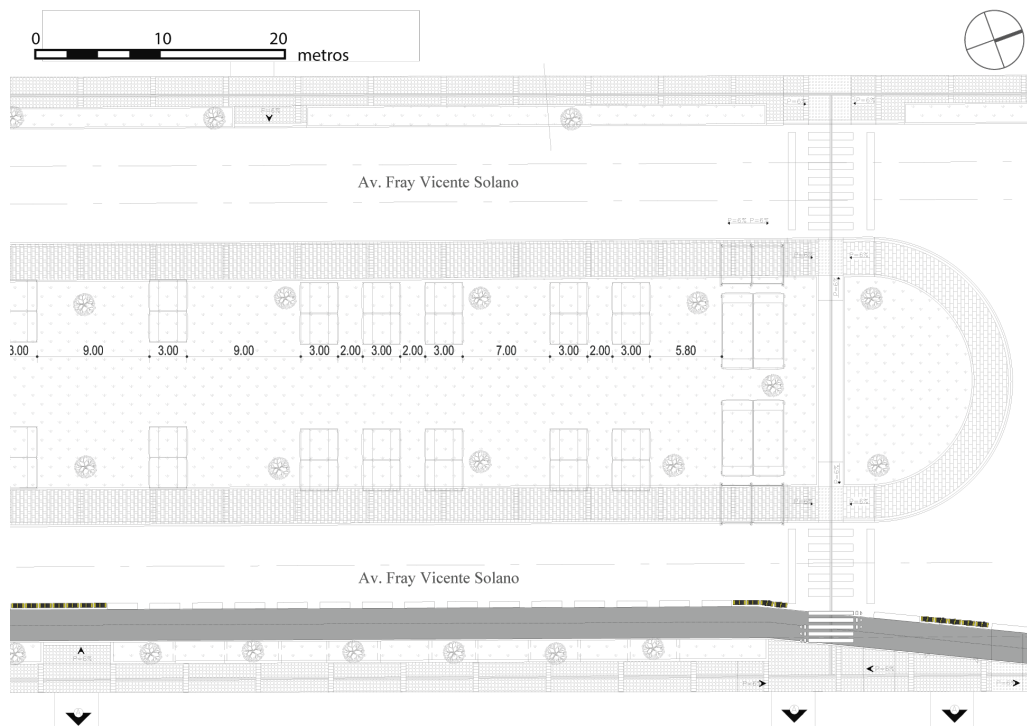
Emplazamiento del Tramo 2B. Elaboración: Autores.
